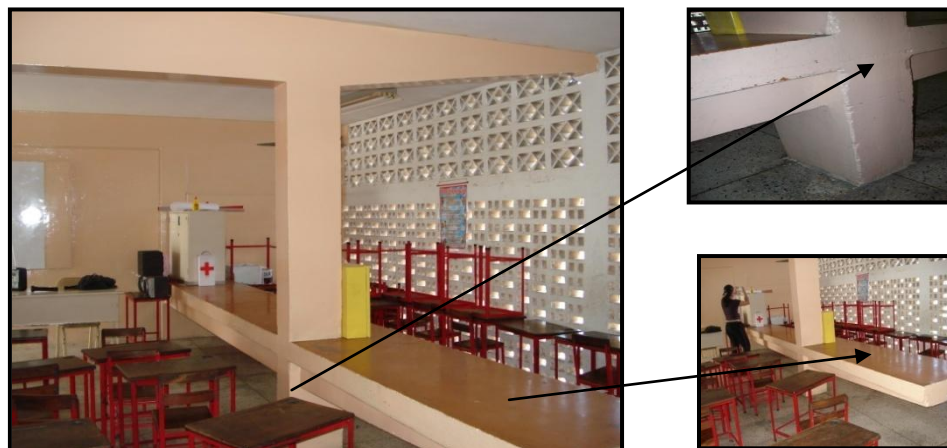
Banquito de concreto dentro de los salones de clase.
